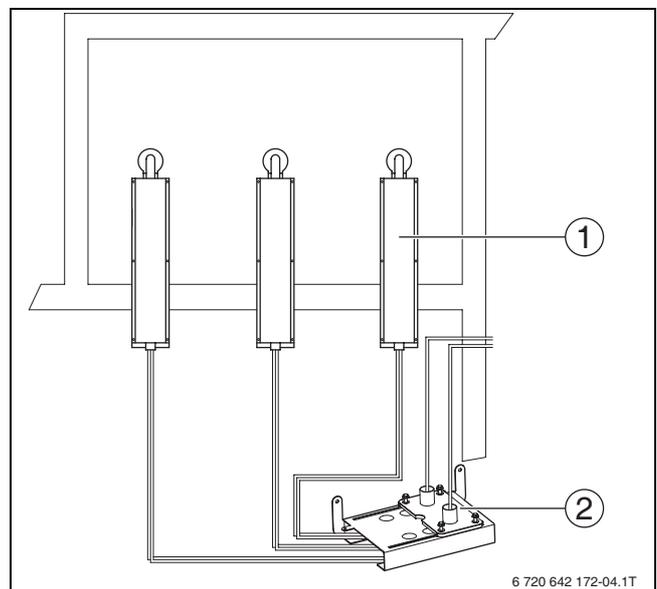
Anschlussschema Sonden mit Schlauchweiche
